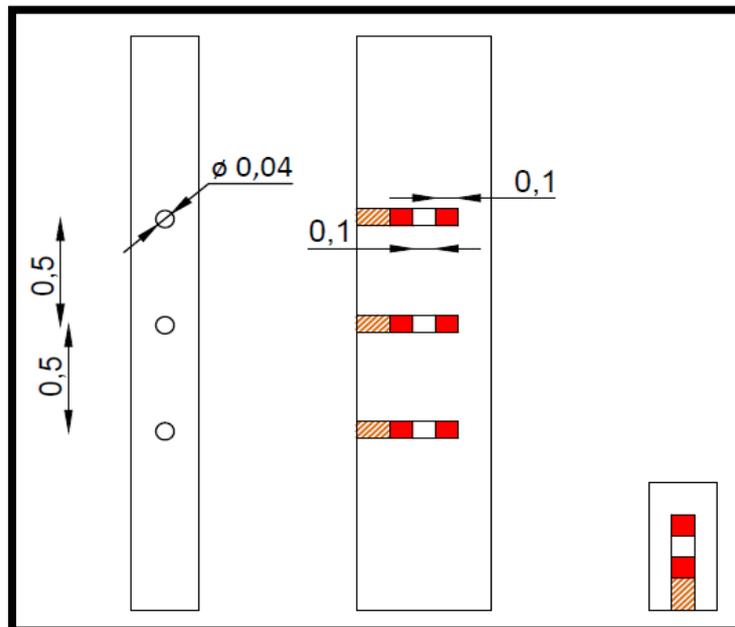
Alzado, perfil y planta del pilar "Básico 2".
